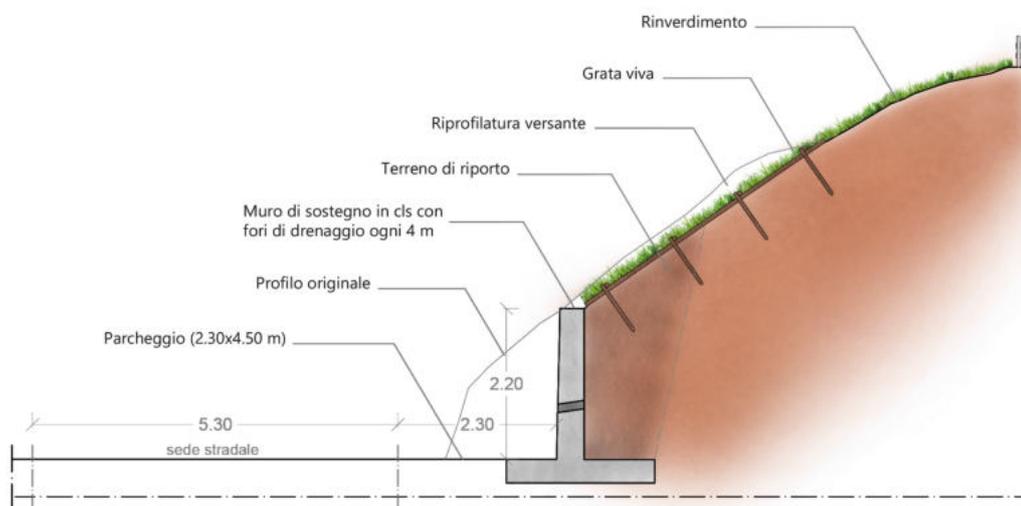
Sezione tipo dell'intervento previsto in zona 5.
